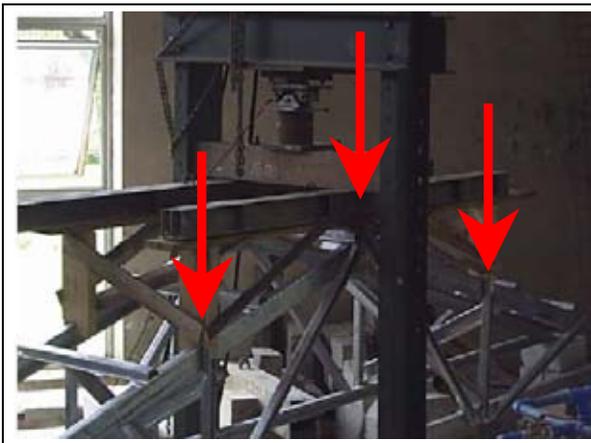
ensayo practicado a modulo de cerchas sin refuerzos
